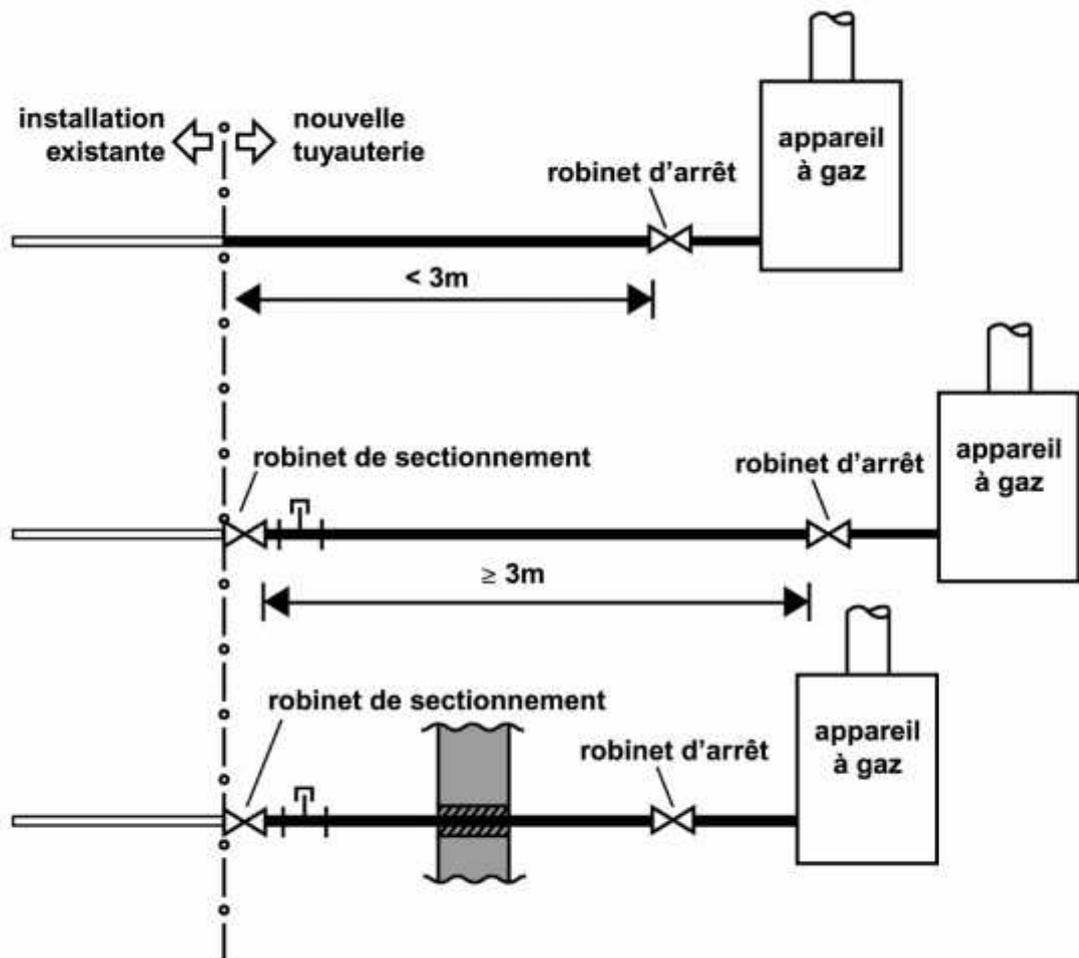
Illustration de la situation a : Robinet de sectionnement en cas d'extension d'une installation
